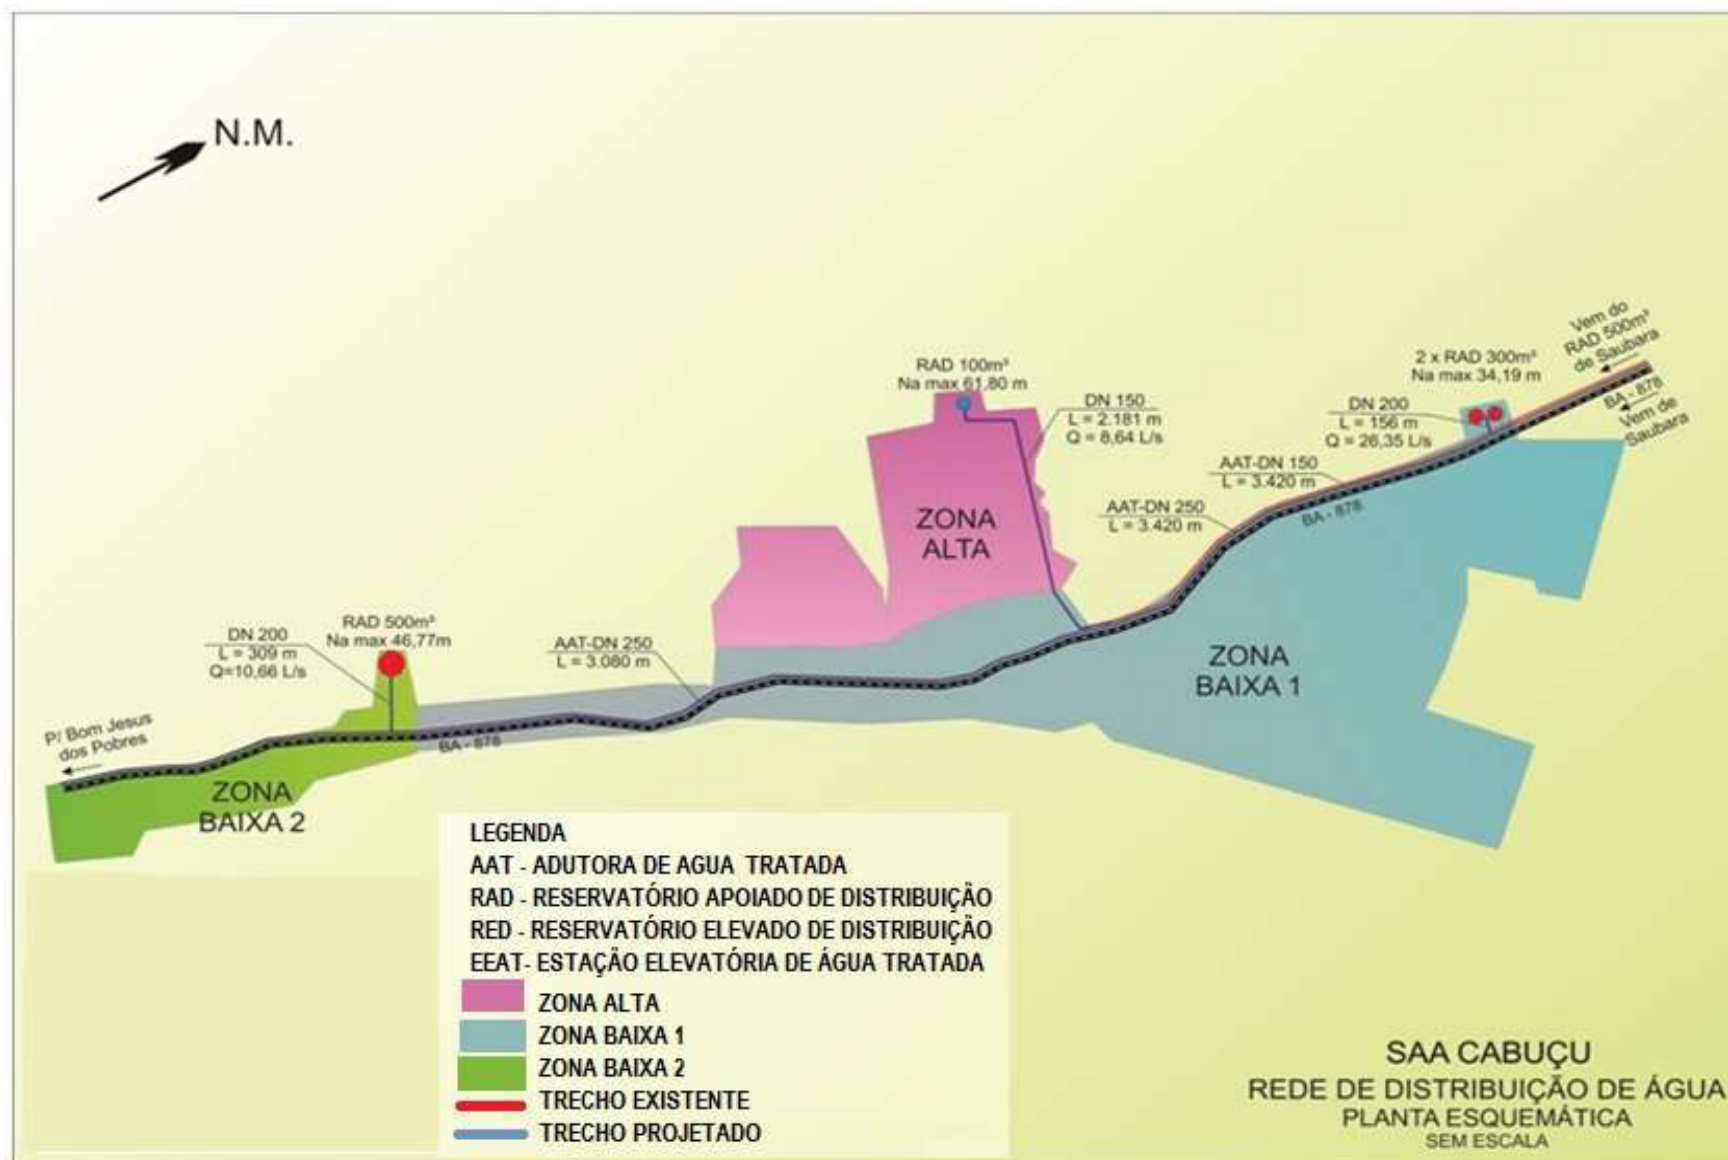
Planta esquemática das unidades principais e zonas de pressão - Cabuçu
